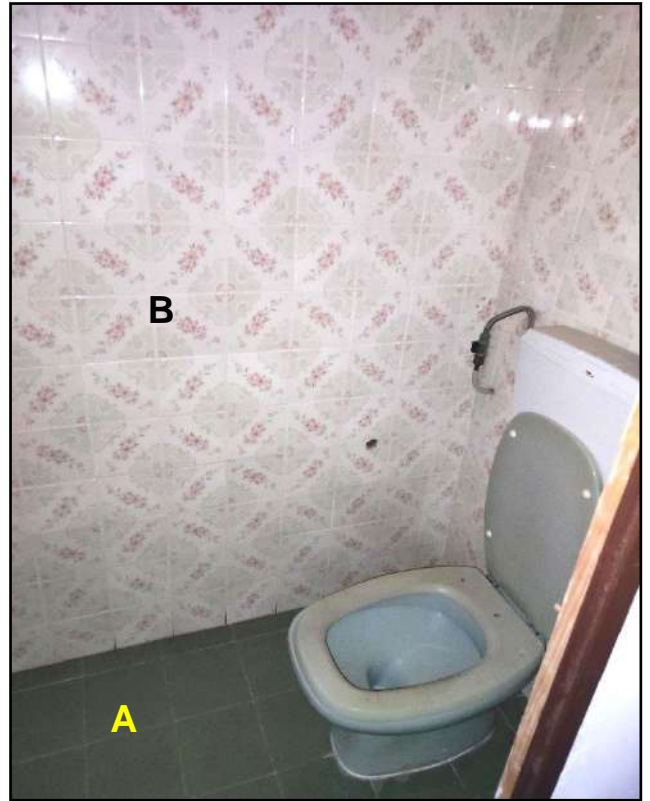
W.C. con pavimento in piastrelle ceramiche formato cm. 20 x 20 (A) (B) rivestimento parietale con piastrelle formato cm.10 x10 per h= m.3,05
